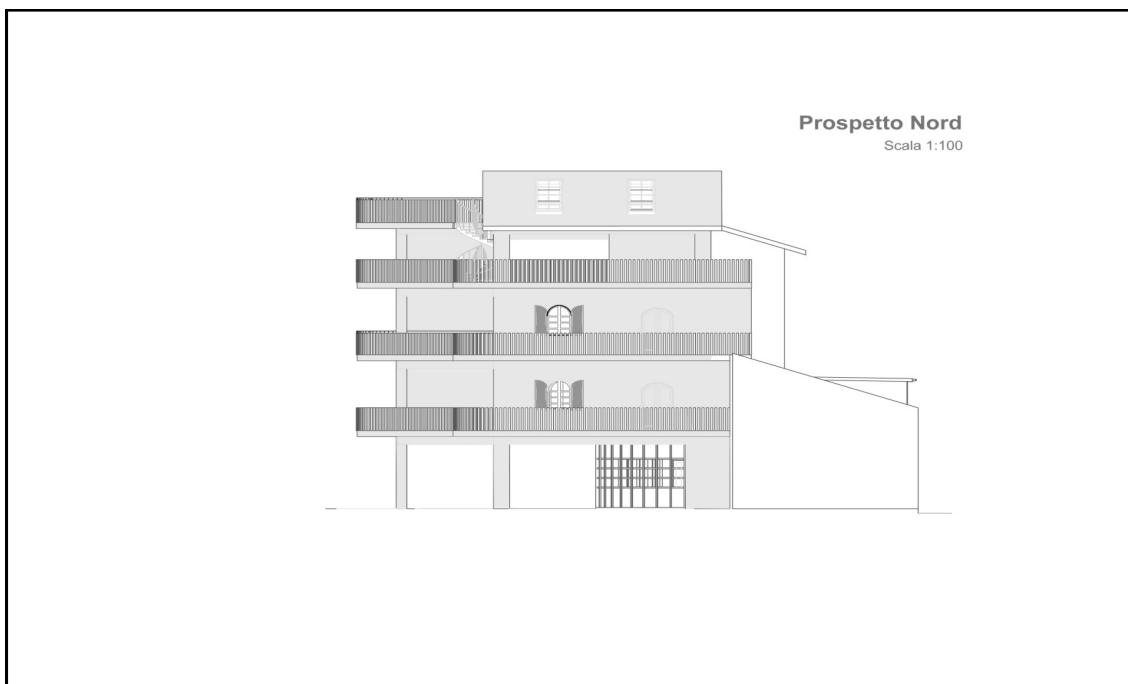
Prospetto edificio a Reggio Calabria con piano pilotis
